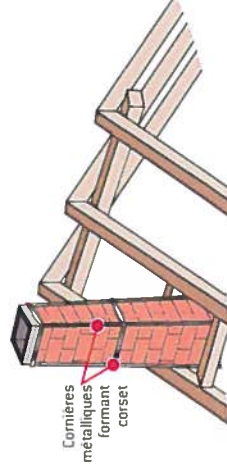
Renforcement des structures secondaires : cheminées, marquises, etc. Exemple de renforcement par chemisage extérieur et cornières métalliques
